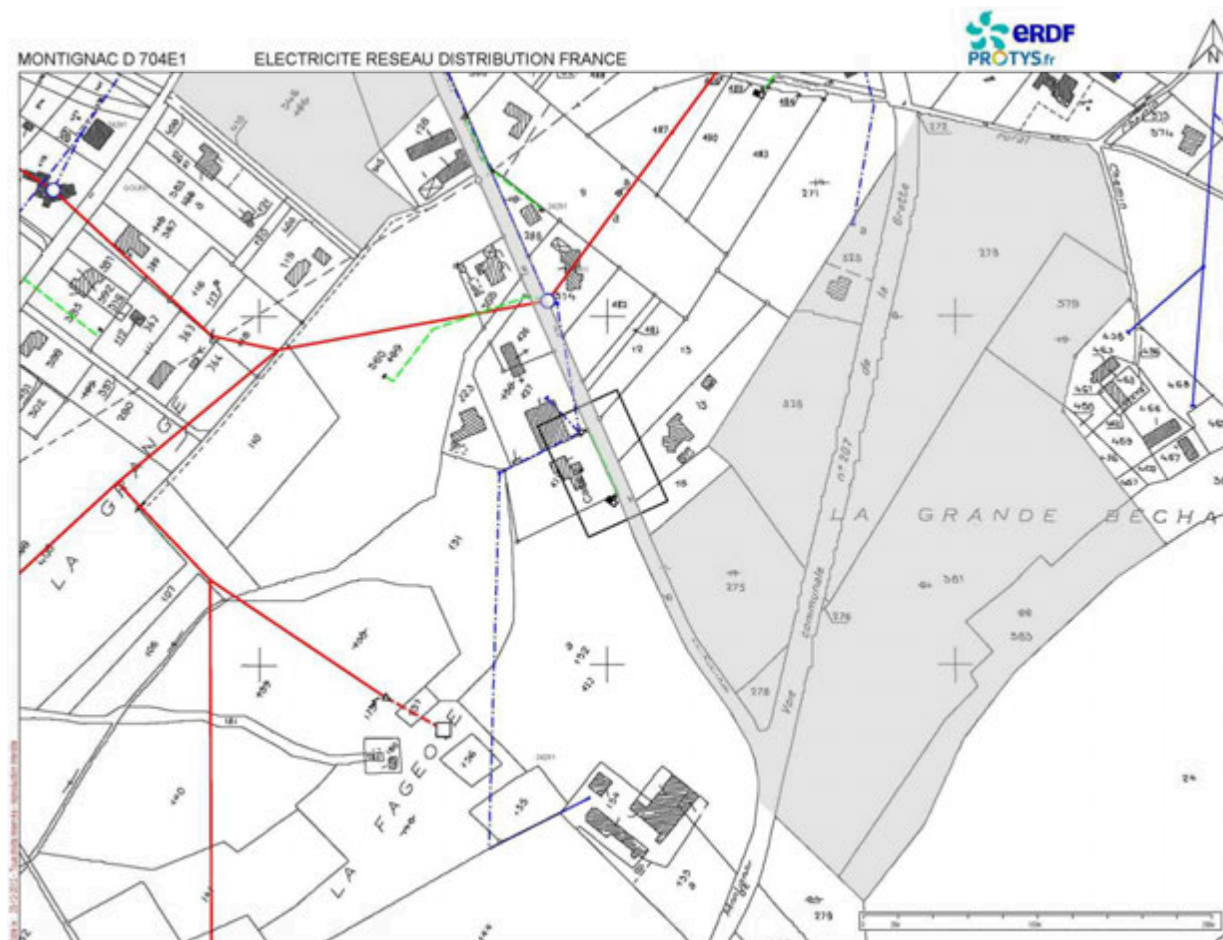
Plan du réseau EDF à proximité du site du CIAPML (Source : ERDF)
